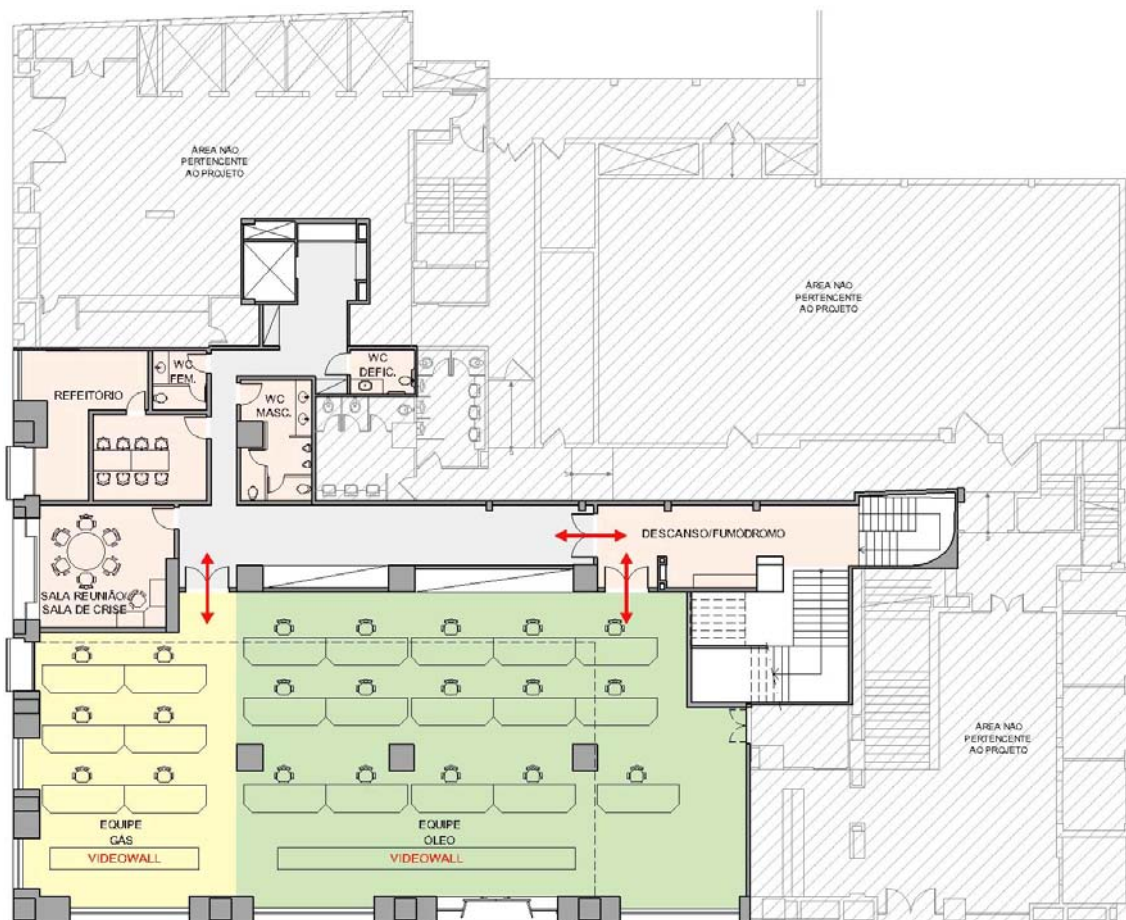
Planta baixa pavimento térreo: opção 1 para o layout (dois de junho)
